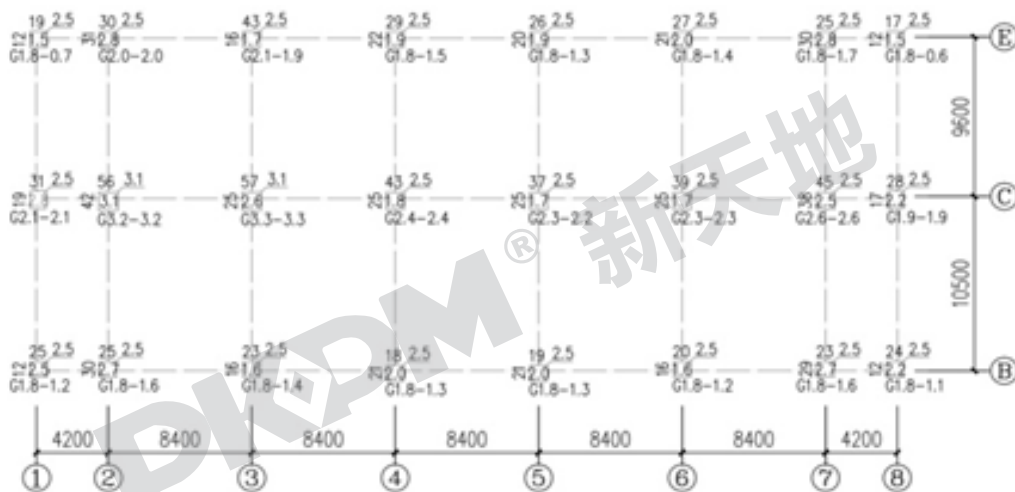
第 4 层混凝土构件配筋简图(单位:cm*cm)
